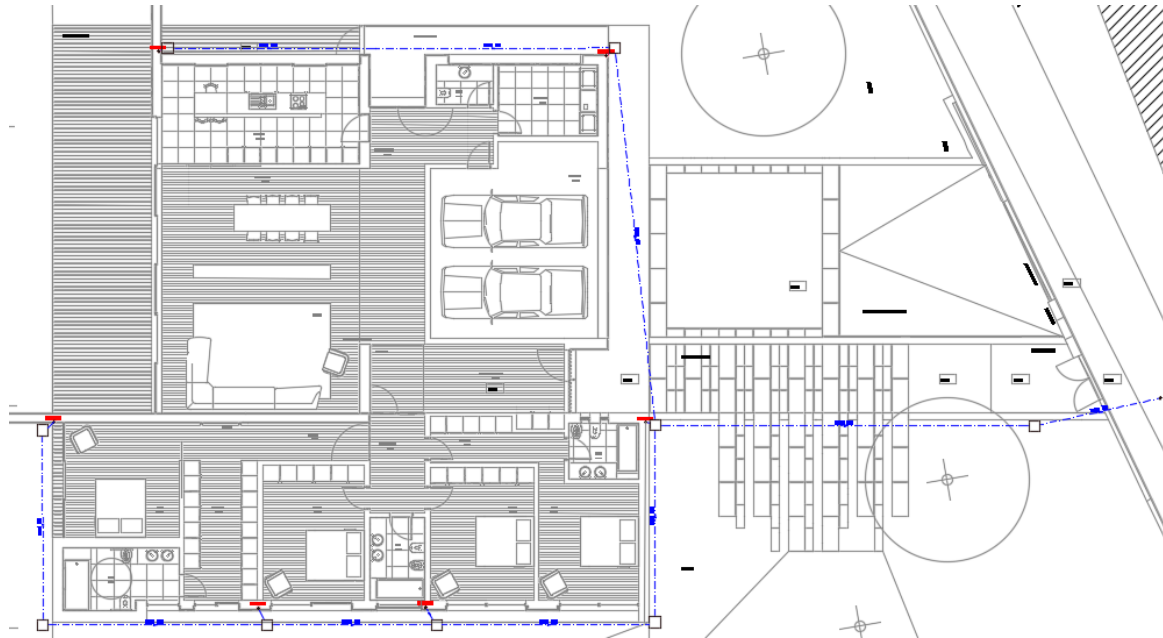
Planta de drenagem de águas pluviais do rés-do-chão.
